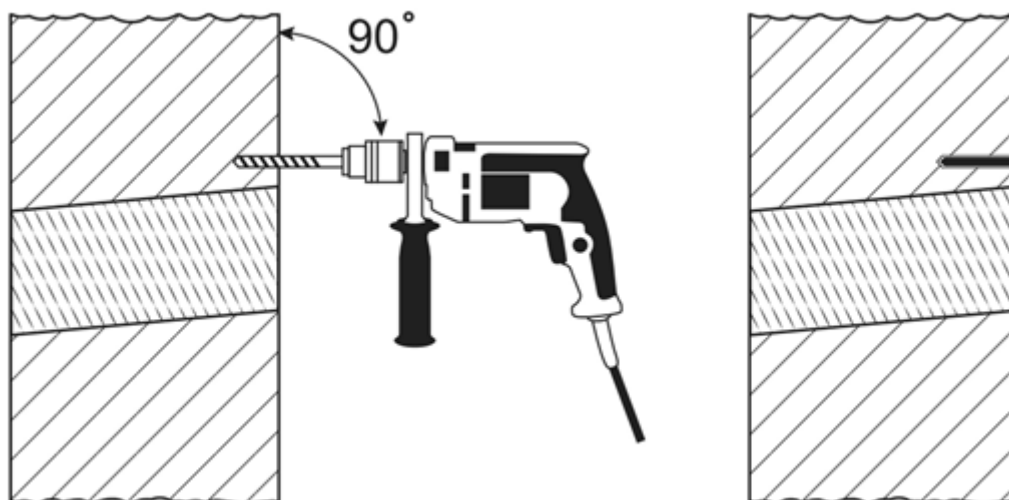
Сверление отверстий под дюбель-гвозди (анкерные болты)
